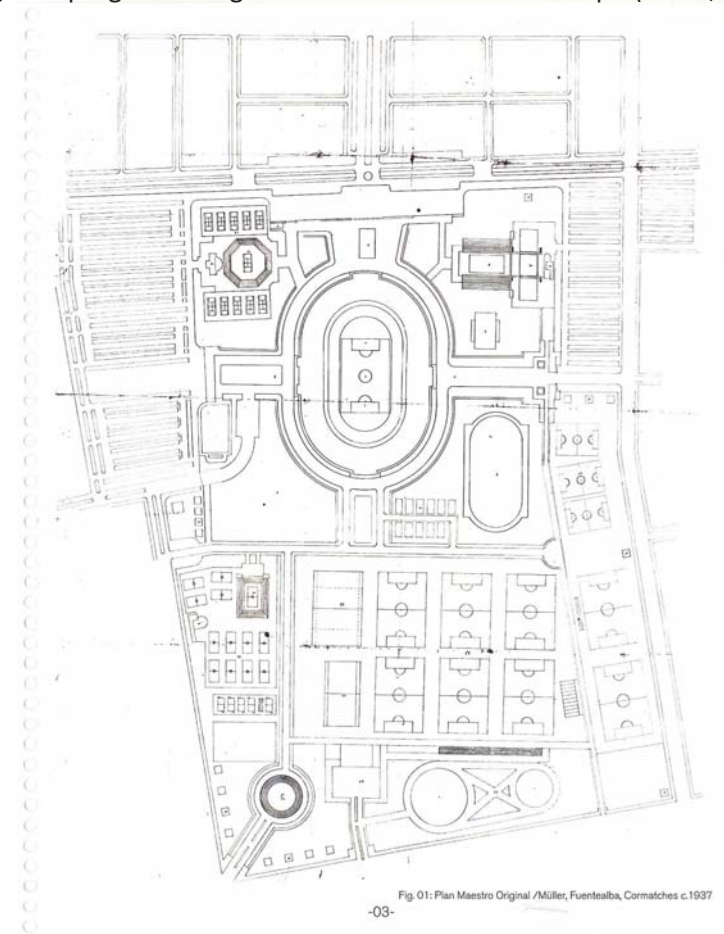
Plan Maestro Original /Müller, Fuentealba, Cormatches c.1937
